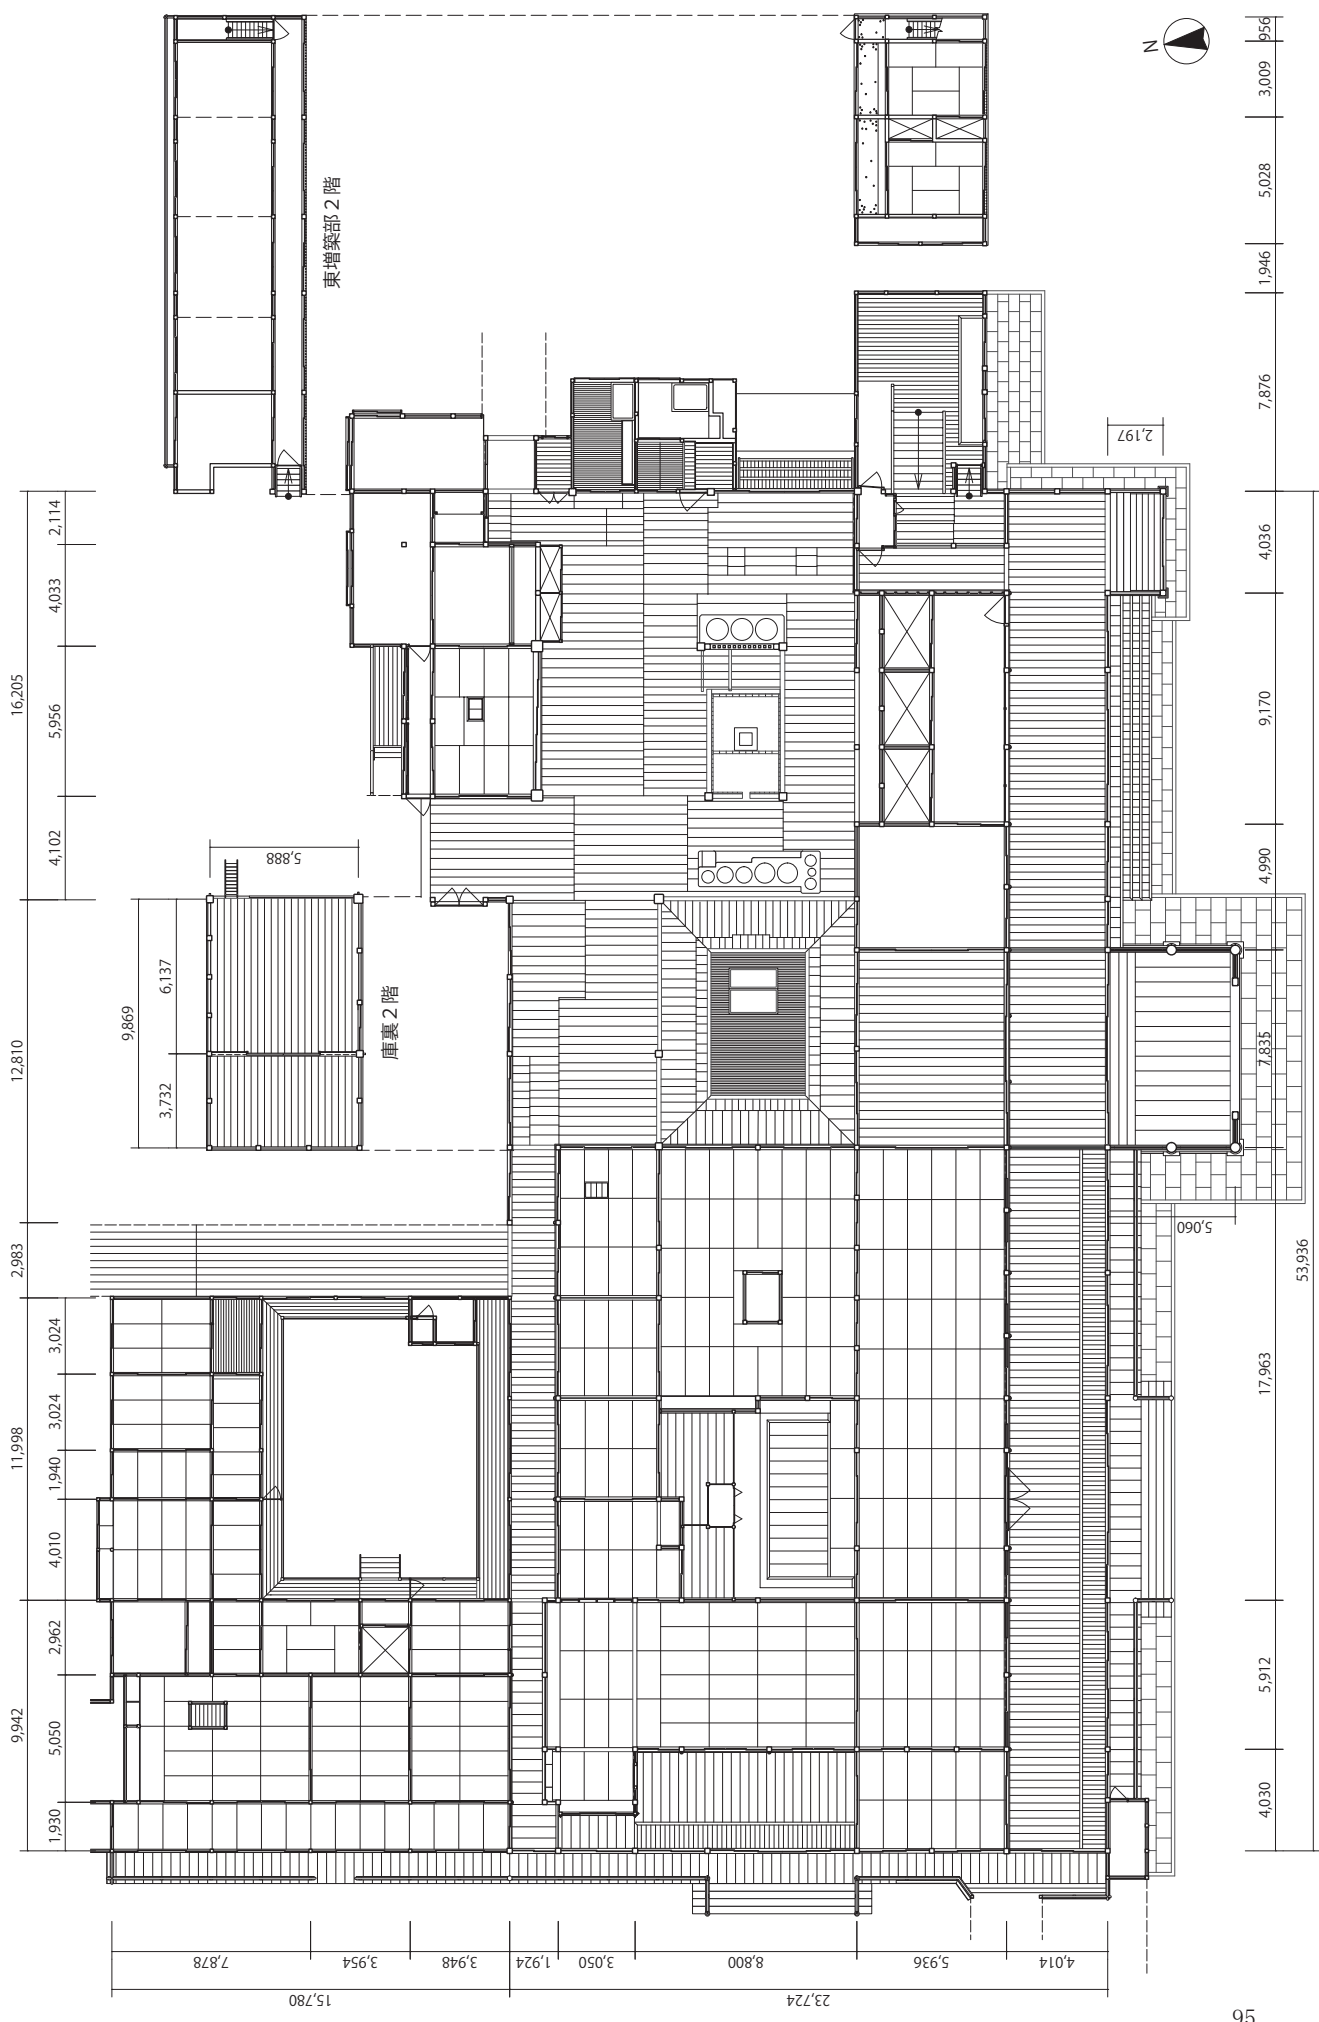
金剛峯寺大主殿・奥書院平面图 1 : 300
